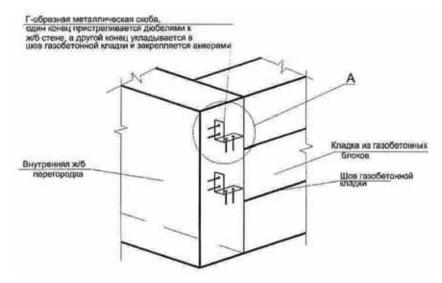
Схема расположения механических связей в кладке стен из газобетона
